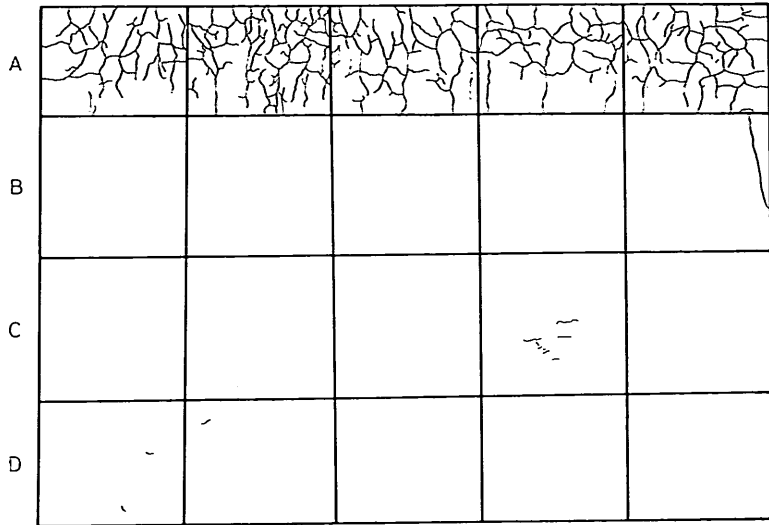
ひびわれ調査図（施工後6ヶ月）
